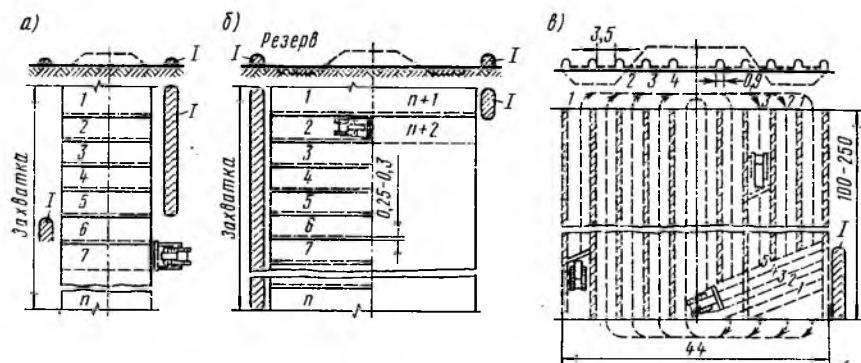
Схемы срезки и перемещения растительного грунта:
